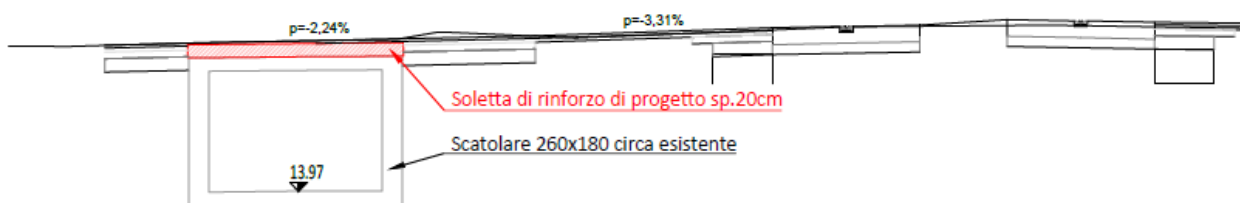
sezione di intervento - rinforzo strutturale dello scatolare
